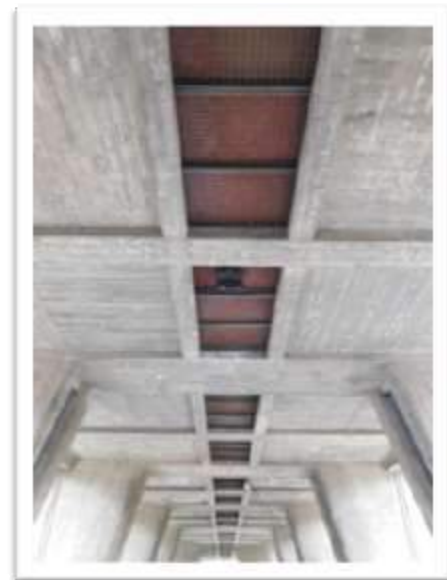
Pavimento técnico acima dos pilotis. Fonte: Arquivo pessoal
